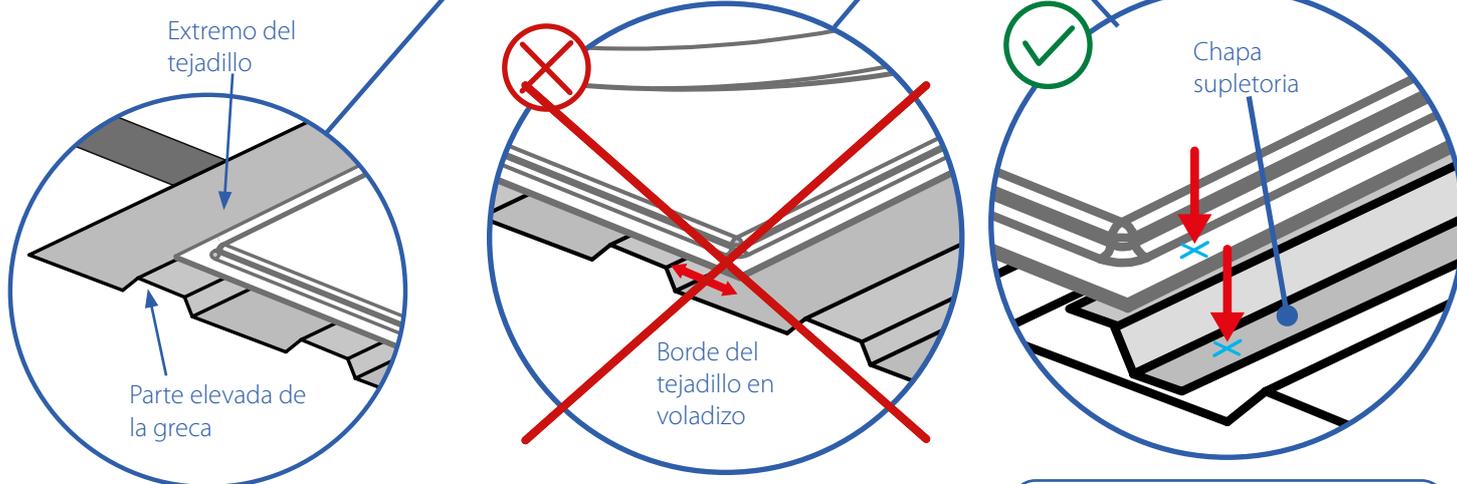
Extremo del tejadillo en voladizo instalado incorrectamente.
